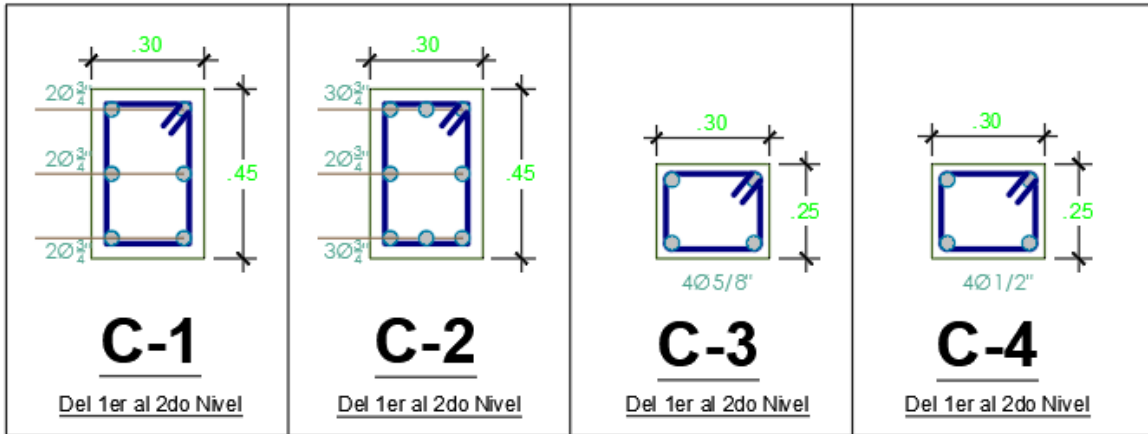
Secciones transversales de columnas, Piso 1 - Bloque 2
